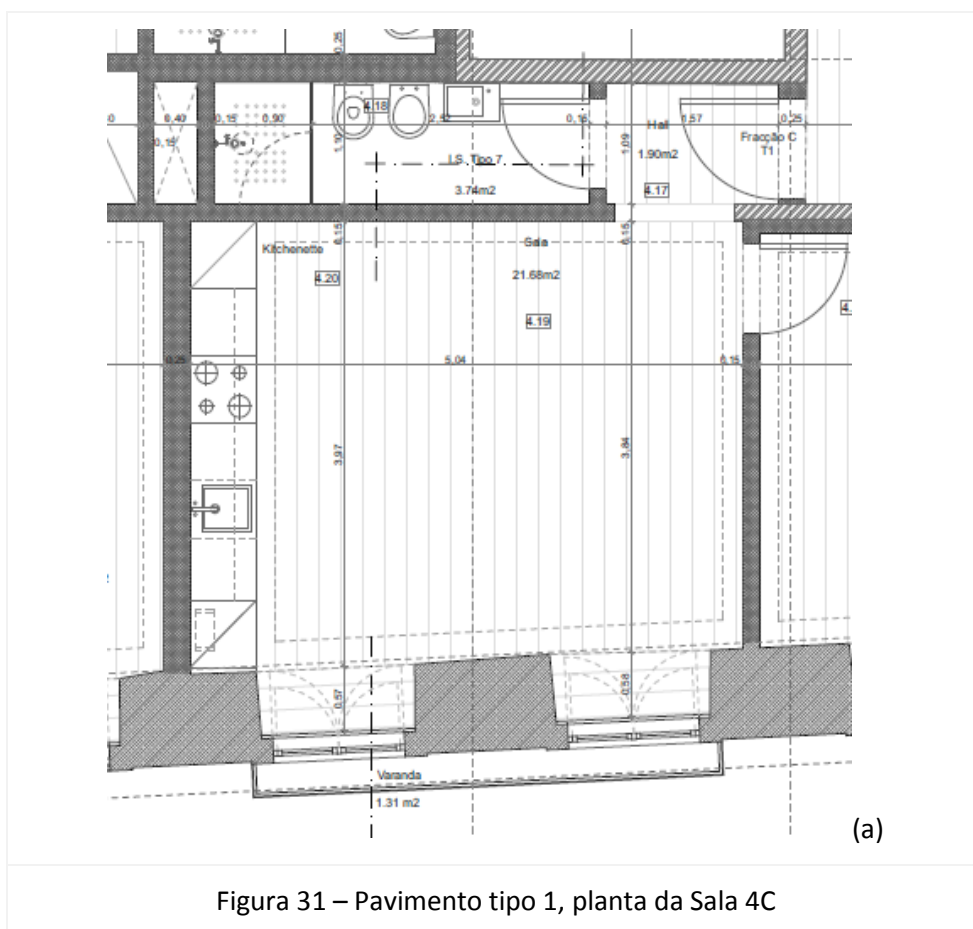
Pavimento tipo 1, planta da Sala 4C
